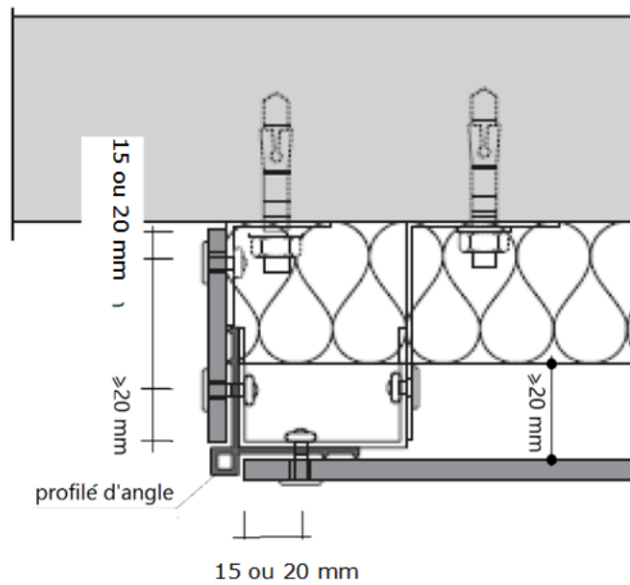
Arrêt latéral de façade sur ossature acier/bridée
